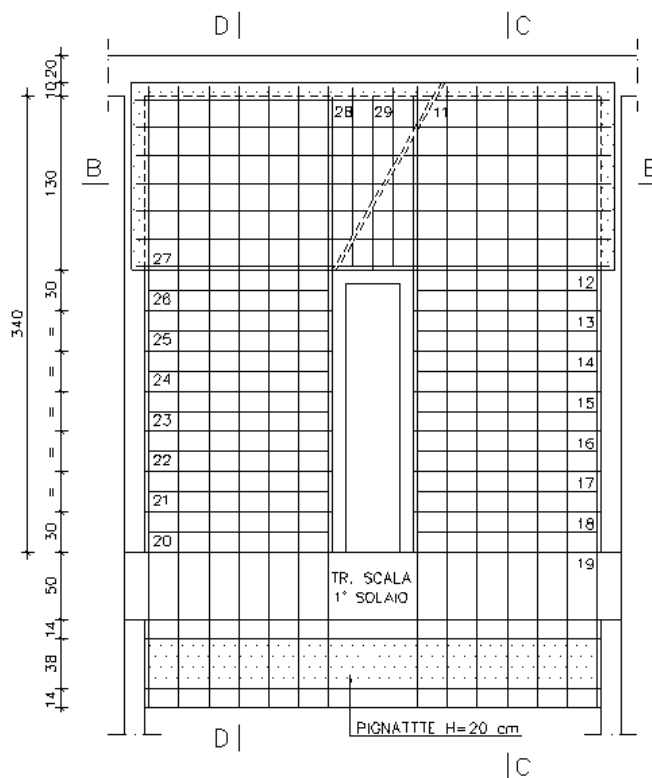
Ex-Lavanderie - stato di progetto: pianta tipo rampe scale
